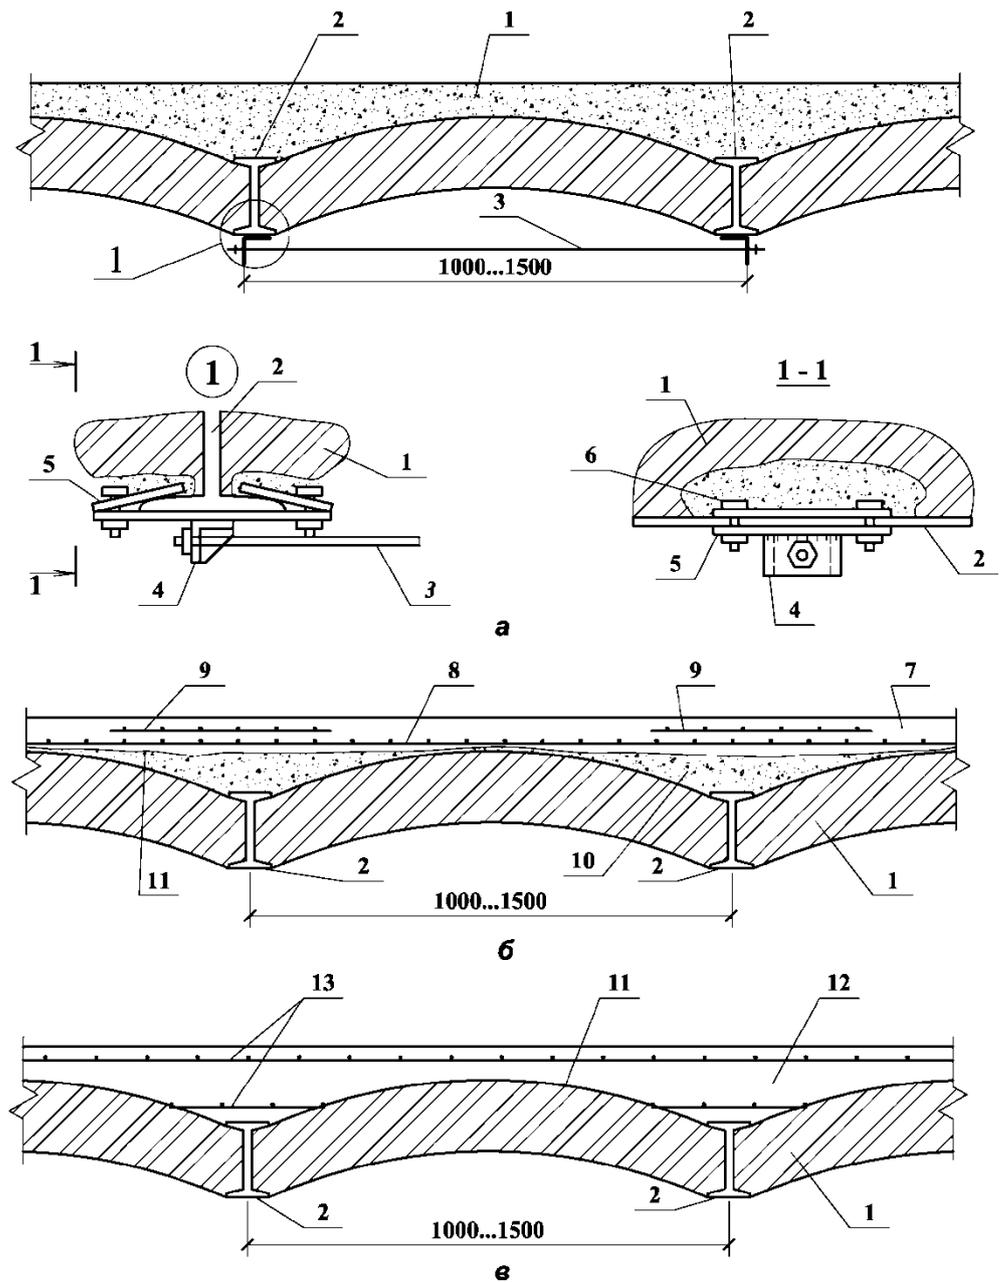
Усиление каменных перекрытий: а – установкой затяжек для восприятия распора; б – наращиванием железобетонной плиты сверху; в – наращиванием железобетонной арочной плиты сверху; 1 – свод из каменной кладки; 2 – несущие металлические балки (двутавр, рельс); 3 – затяжка из арматурных стержней с гайками на концах; 4 – упор для затяжки в виде стального уголка с ребрами жесткости; 5 – крепление упора к полке балки с помощью пластин и болтов; 6 – ниши в перекрытии (после устройства крепления заполнить раствором); 7 – наращиваемая железобетонная плита; 8 – нижние пролетные арматурные сетки усиления; 9 – верхние надопорные арматурные сетки усиления; 10 – забутовка из боя кирпича на растворе; 11 – поверхность перекрытия, подготовленная к бетонированию; 12 – наращиваемая арочная железобетонная плита; 13 – арматурные сетки
